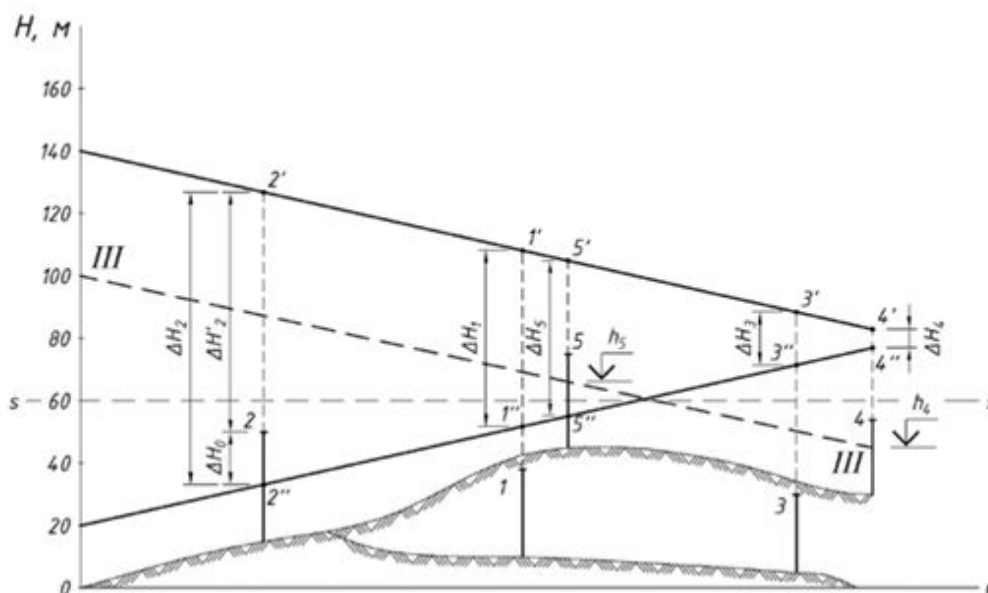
Выбор схем присоединения отопительных установок зданий к теплосети:
